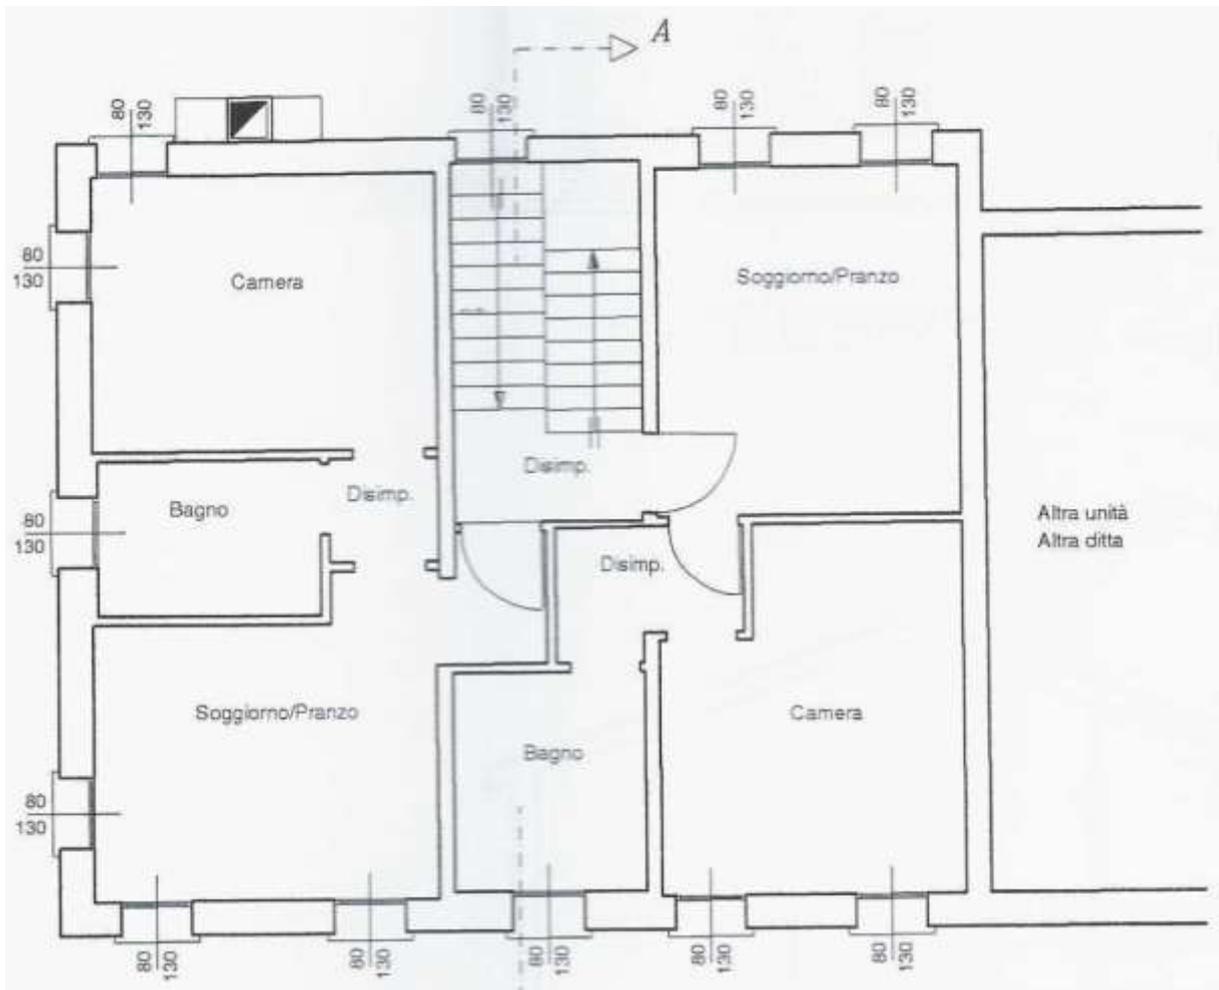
PIANTA PIANO INTERRATO (fuori scala)
